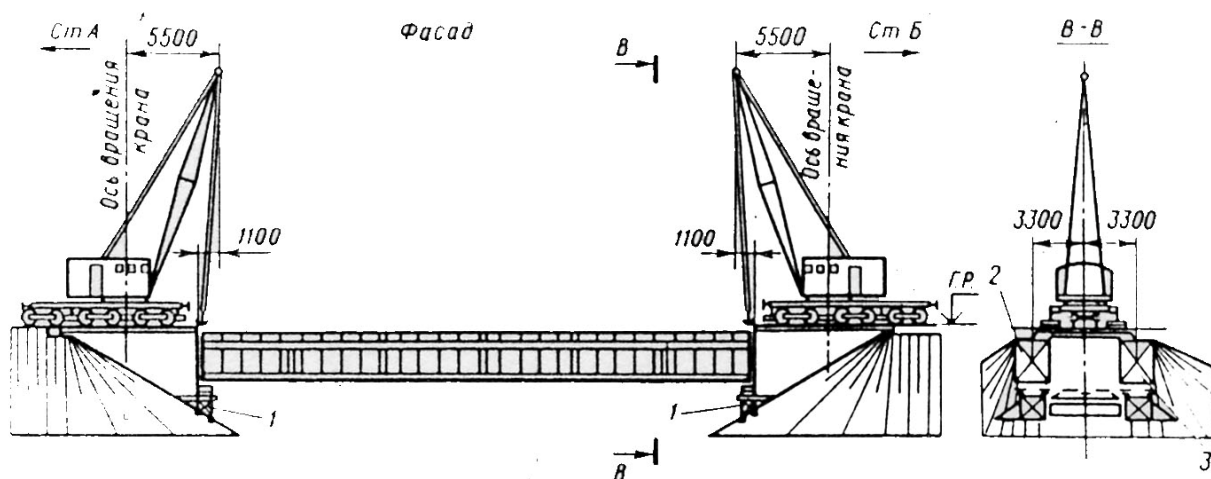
Технологическая схема замены пролетного строения двумя кранами: 1 – деревянные рамно-лежневые подмости; 2 – старое пролетное строение на подмостях; 3 – новое пролетное строение на подмостях
